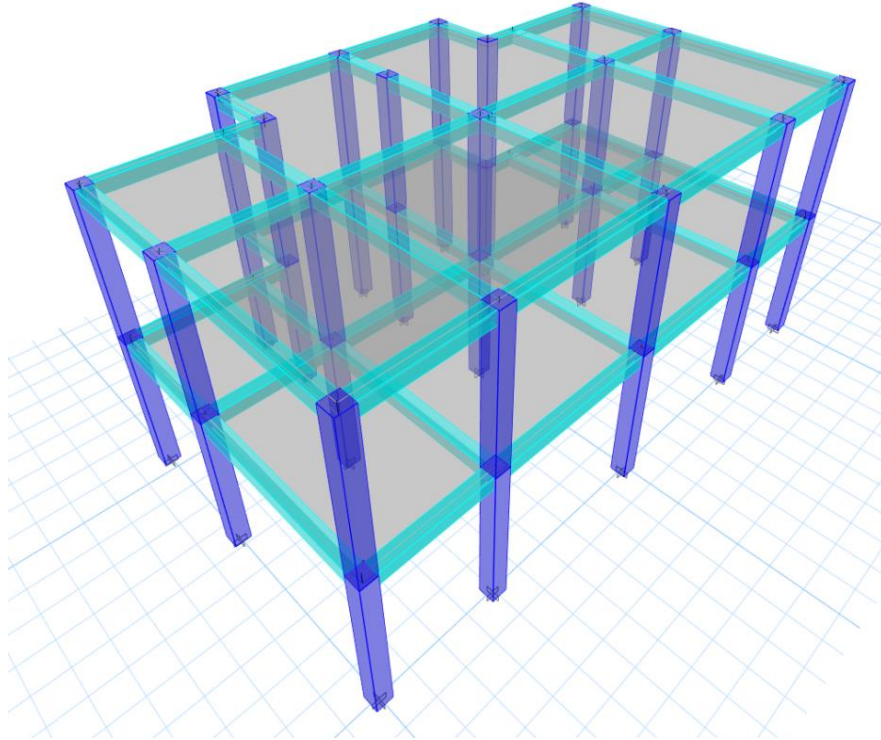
Planta baja estructura de hormigón armado. Fuente: Propia
